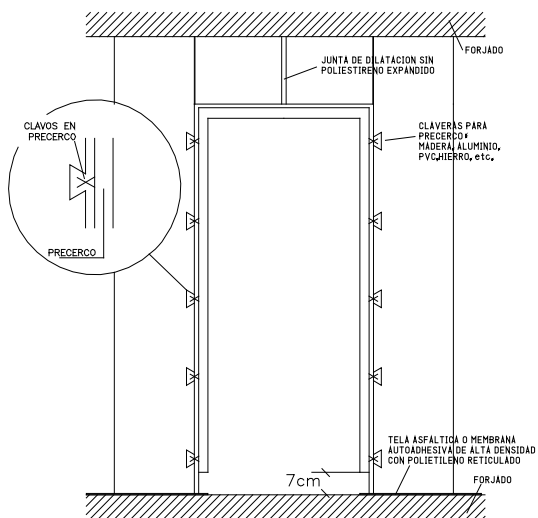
COLOCACIÓN DE CABECEROS Y PRECEROS CON ESPUMA
